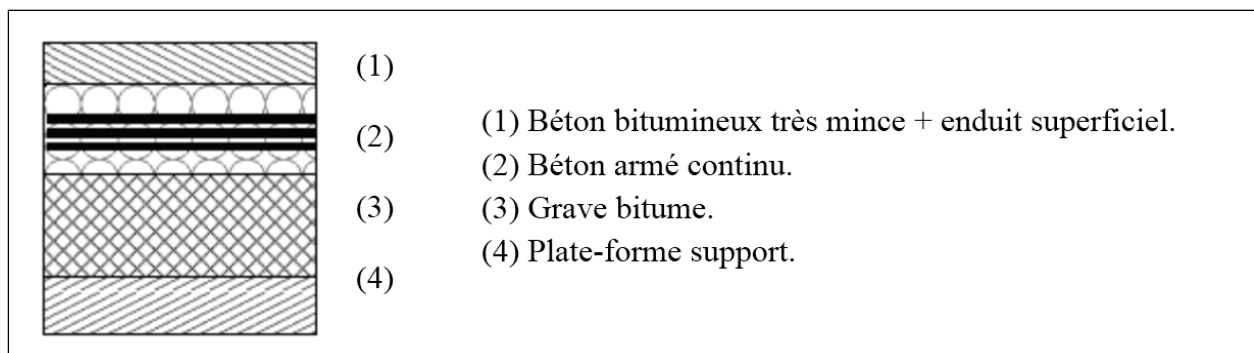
Structure d'une chaussée en béton armé continu sur grave bitume (MEZIANI, 2008)
